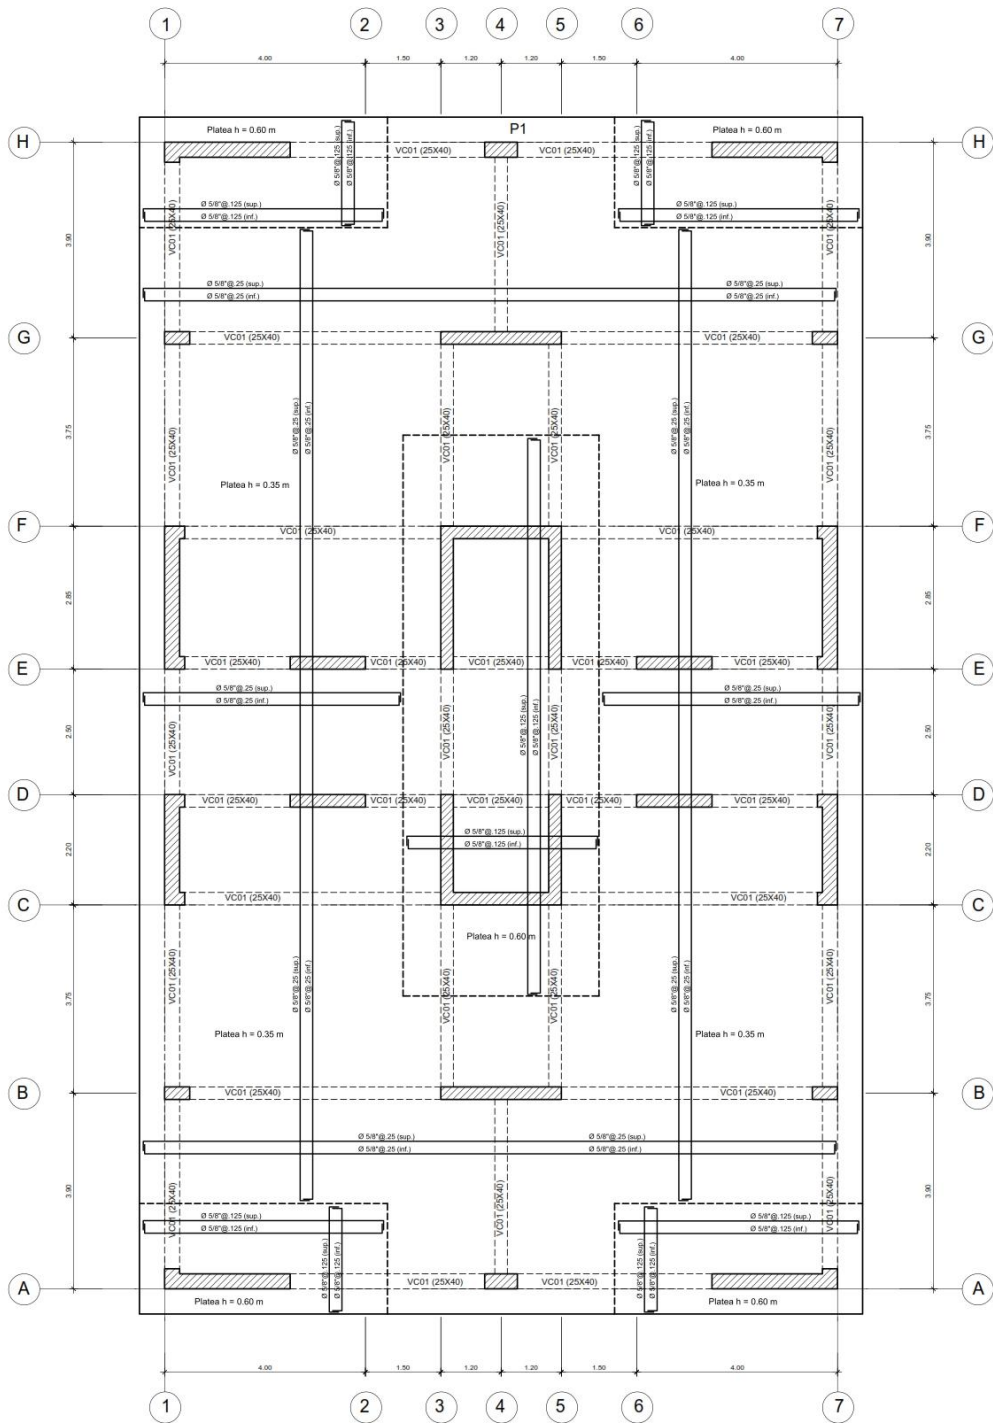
Refuerzo final en platea de cimentación de edificación con disipadores
